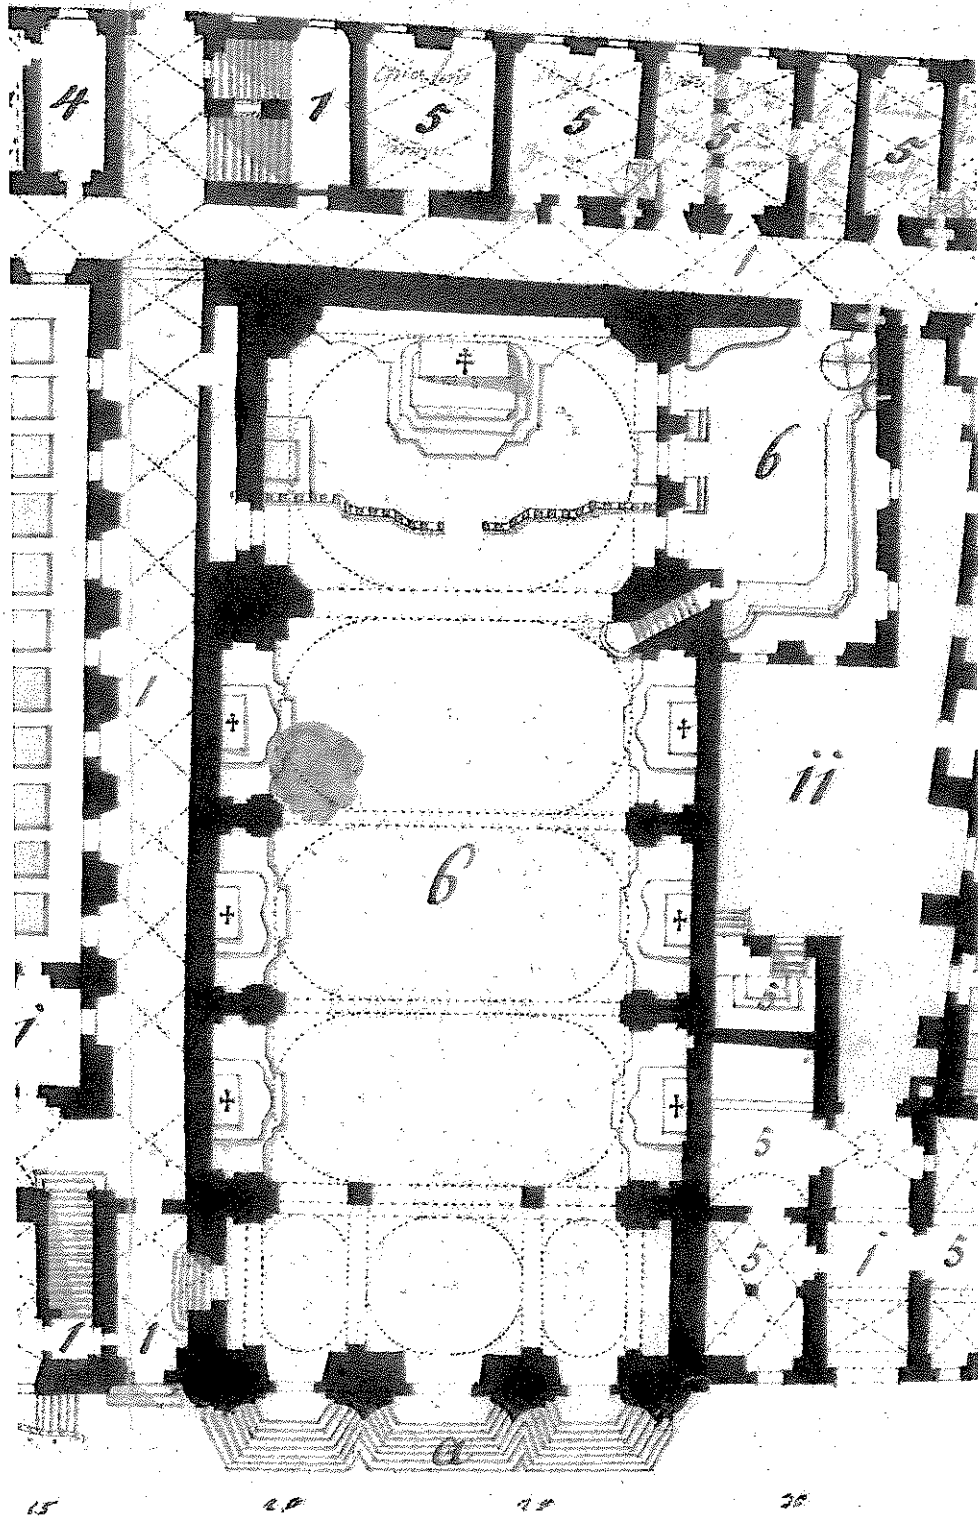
Christoph Stadler, Kloster und Spital der Barmherzigen Brüder mit Barmherzigenkirche, Zeichnung, um 1811, Ausschnitt Grundriss der Klosterkirche, Erdgeschoss.
